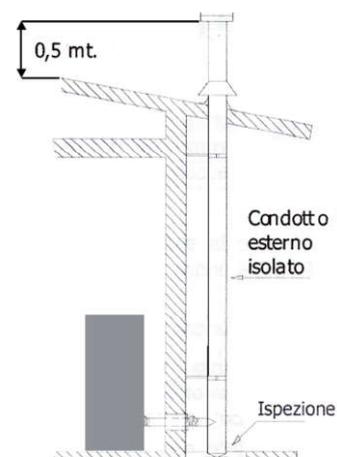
collegamento ad un condotto esterno con tubo isolato o doppia parete
